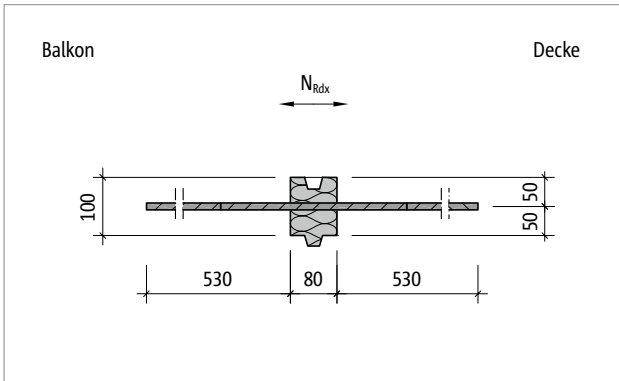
Schöck Isokorb® T Typ H-NN2: Produktgrundriss
